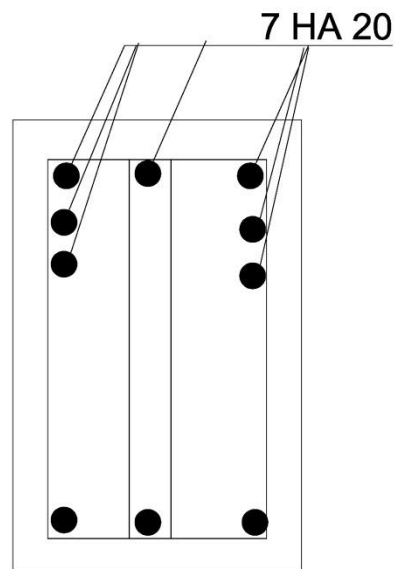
Coupe transversale en travée d'une nervure longitudinale.
